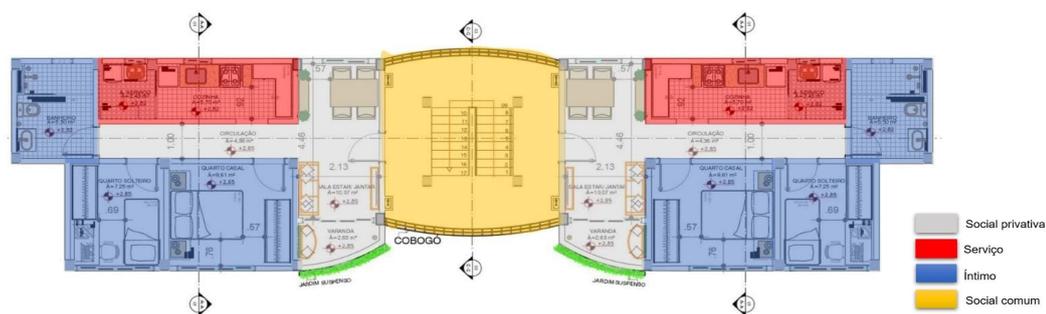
Setorização- Planta baixa- Pavimento térreo acessível
